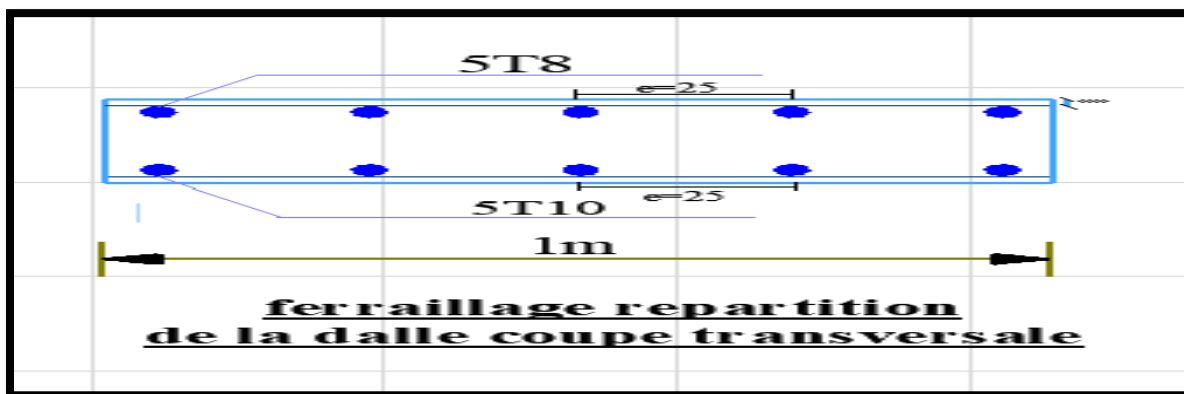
Ferrailage répartition de la dalle Coupe transversale du tablier
